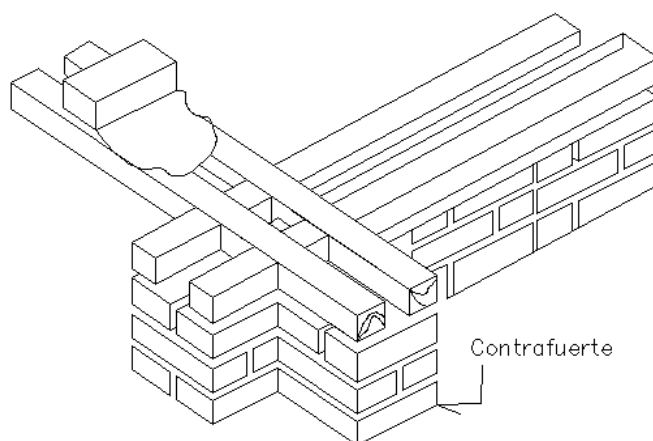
Refuerzo con tirantes de muros de mampostería
